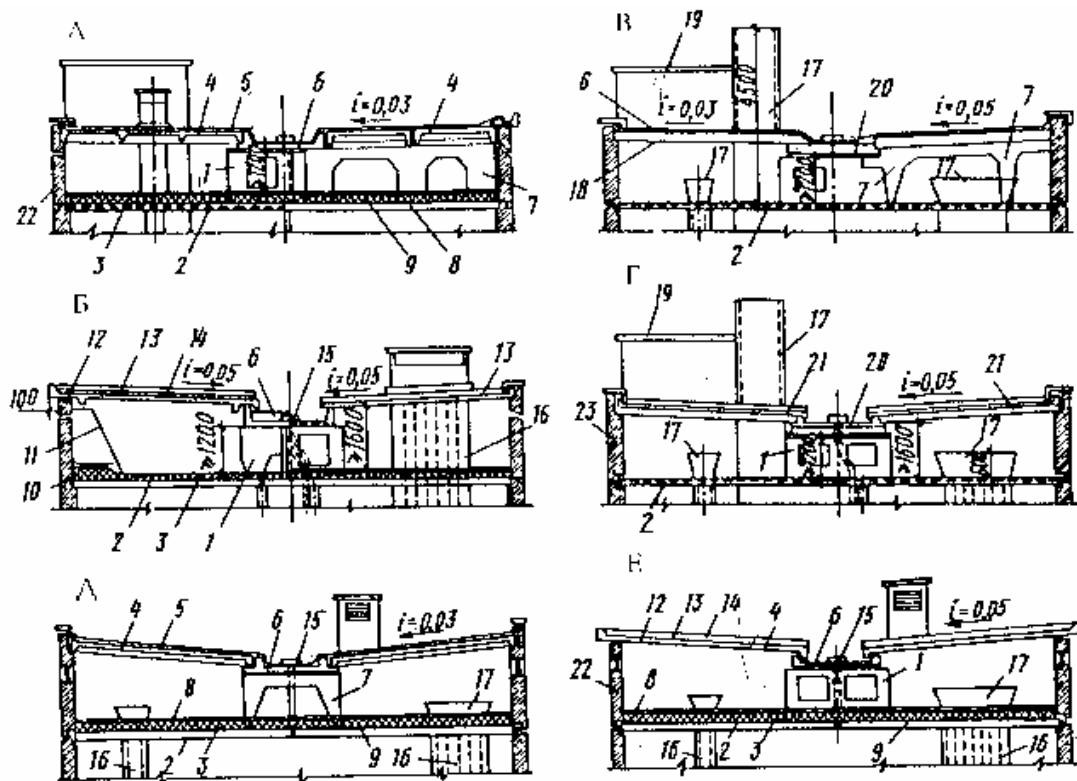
Схемы конструкций чердачных крыш: А, В – с холодным чердаком с рулонной (А) и безрулонной (В) кровлей; В, Г – с теплым чердаком с рулонной (В) и безрулонной (Г) кровлей; Д, Е – с открытым чердаком с рулонной (Д) и безрулонной (Е) кровлей; 1 – опорный элемент; 2 – плита чердачного перекрытия; 3 – утеплитель; 4 – неутепленная кровельная плита; 5 – рулонный ковер; 6 – водосборный лоток; 7 – опорная рана; 8 – защитный слой; 9 – пароизоляционный слой; 10 – поноса рубероида; 11 – опорный элемент фризовой панели; 12 – кровельная плита безрулонной крыши; 13 – гидроизоляционный слой из мастичных или окрасочных составов; 14 – П-образная плита-нашельник; 15 – водосточная воронка; 16 – вентиляционный блок (шахта); 17 – оголовок вентиляционного блока; 18 – легковесная однослойная кровельная плита; 19 – машинное отделение лифта; 20 – легковесная плита лотка; 21 – двухслойная кровельная плита; 22 – неутепленная фризловая панель; 23 – утепленная фризловая панель
